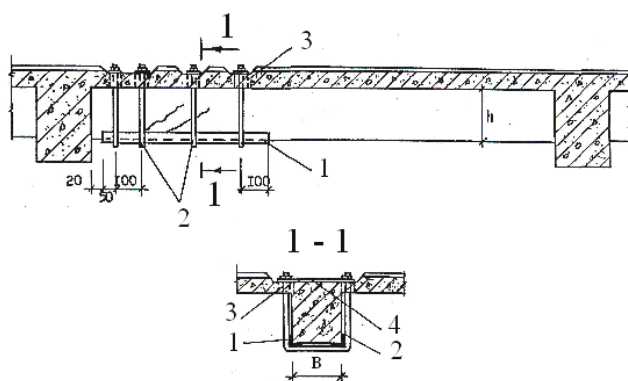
Восстановление железобетонной балки с помощью уголков и хомутов:
